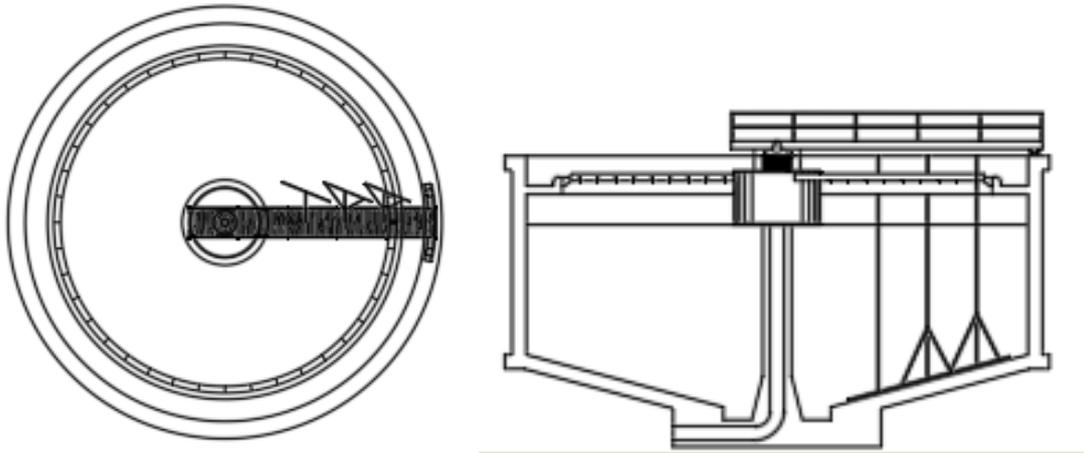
Detalle planta y alzado de decantador 1. Fuente: edición propia
